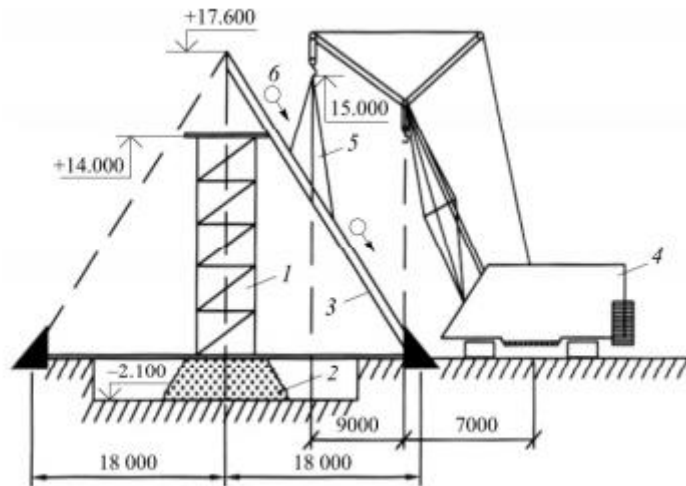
Схема монтажу намету краном СКГ-40, оснащеним гуськом 13 м: 1 – баштова опора; 2 – відсіпання баластної подушки підвалу; 3 – арка, що монтується; 4 – кран; 5 – тригільковий строп; 6 – напрям монтажу другорядних арок та плит покриття
